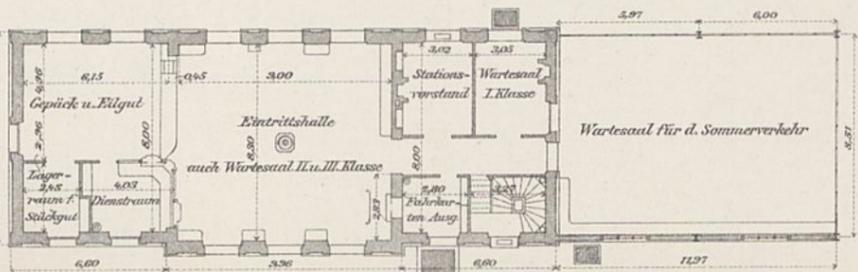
Grundriss eines Stationsgebäudes III. Klasse. 1: 300.
